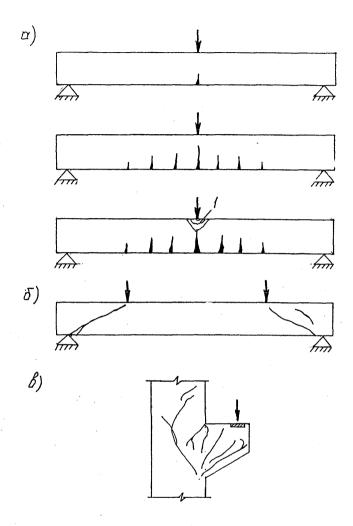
Трещины при разрушении изгибаемых железобетонных элементов
